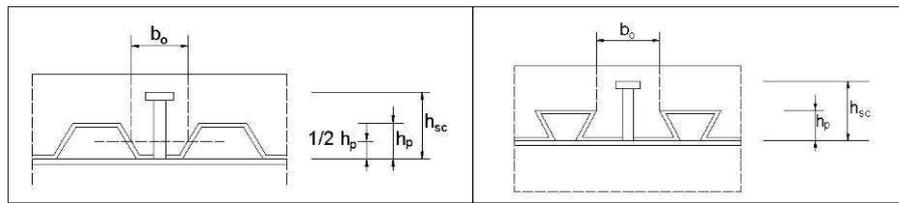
(b) - Disposizione della lamiera grecata rispetto al profilo in acciaio
